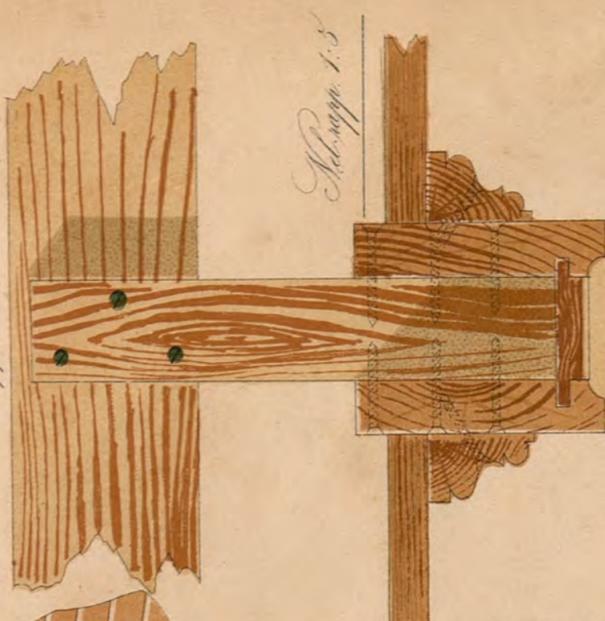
Una porzione del fianco della trave, trave a cassetta della fig. 2
